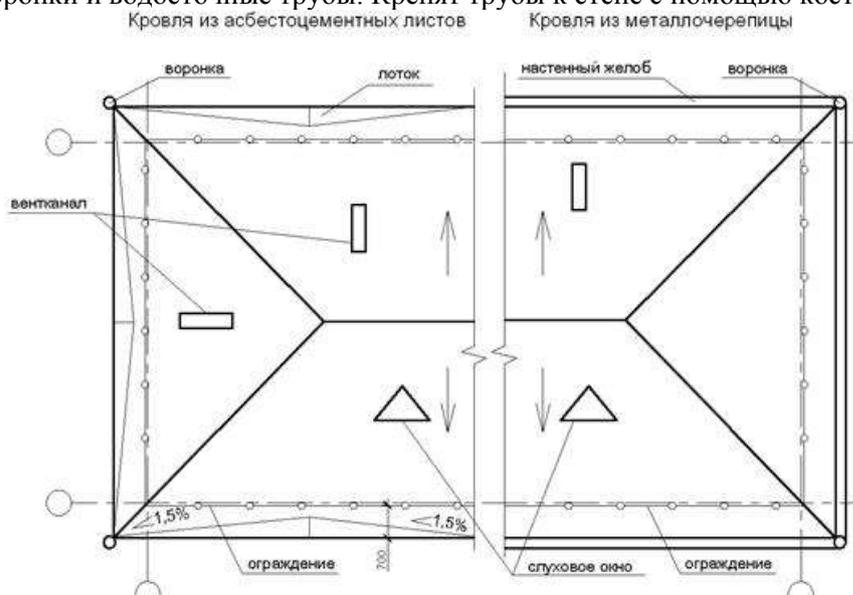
Виды кровли из асбестоцементных листов и кровли из металлочерепицы
